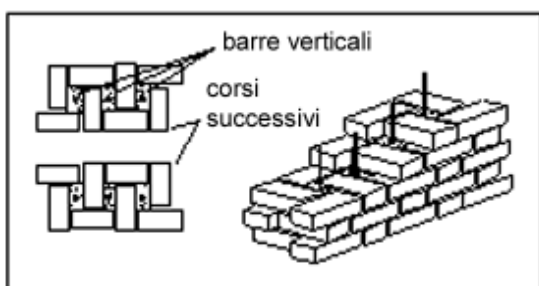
Muratura ad armatura diffusa: disposizione "Quetta" (3)
